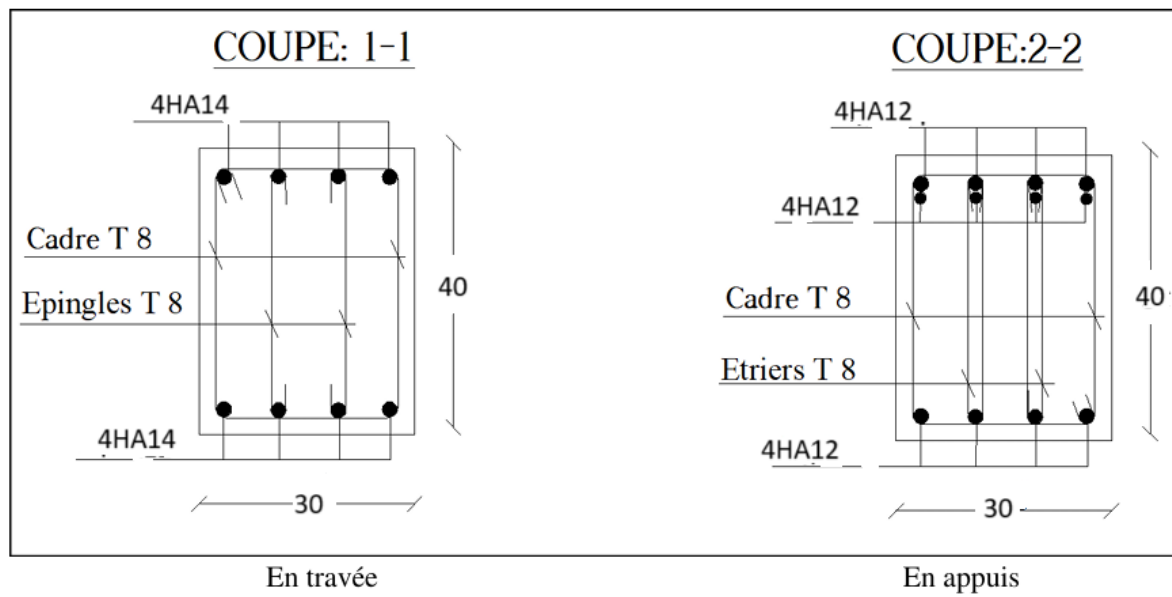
Schéma de ferrailage des poutres secondaires.
